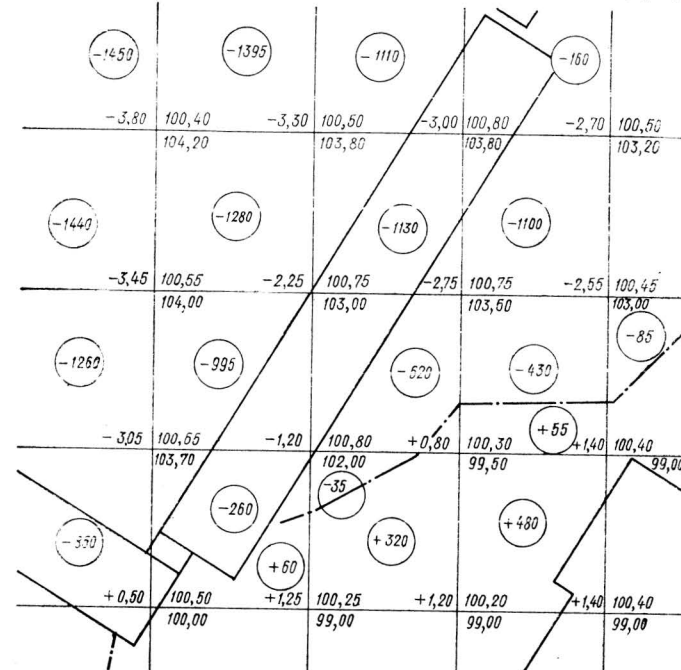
Картограмма земляных работ (для фрагмента вертикальной планировки, показанного на рис. 11.5.1).
